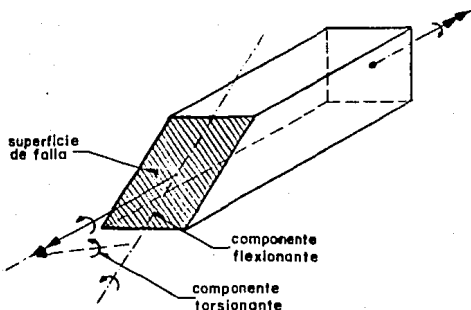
Falla por torsión. Modelo de una viga de concreto simple.
